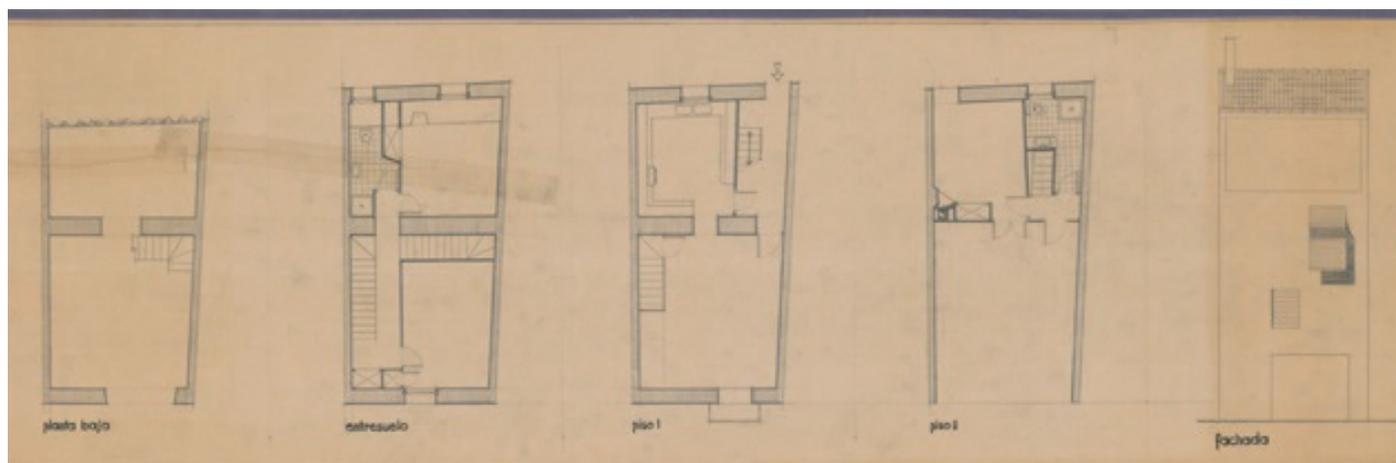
Planimetría Casa Villavecchia. Correa Milá Arquitectes. Arxiu Històric del COAC
